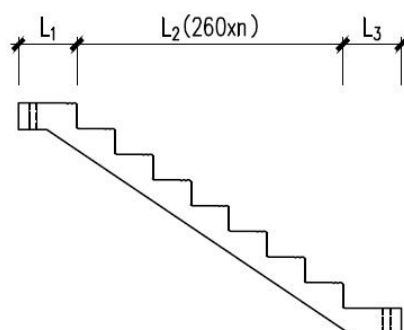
双跑梯 (SAT) 剖面示意图
